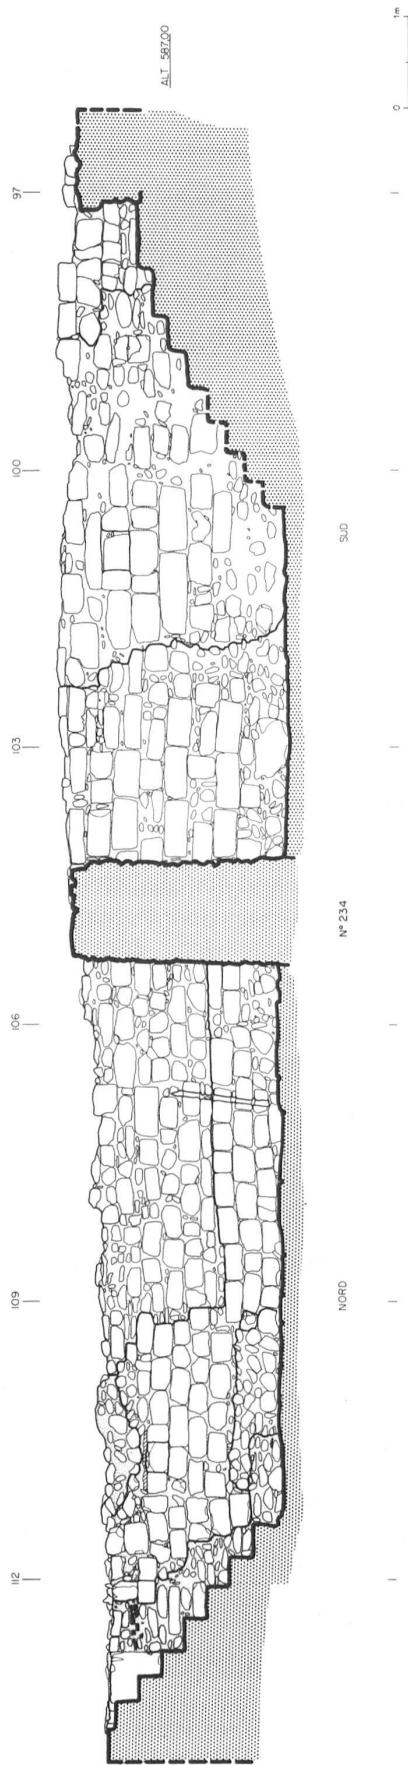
Rue du Pont-Suspendu 74–75. Relevé au pierre à pierre du mur oriental du bâtiment n° 234.
